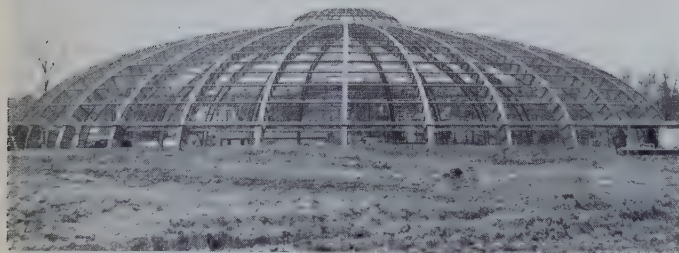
Ansicht der Sporthalle nach der Montage der Stahlkonstruktion
